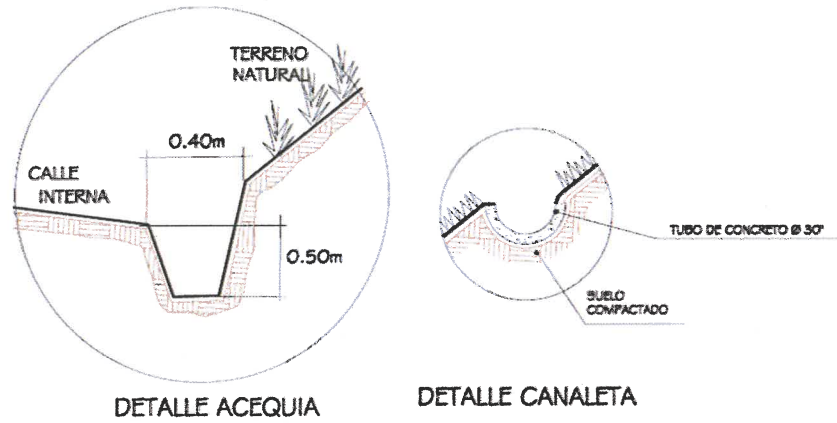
Drenajes Temporales Durante Construcción en el Sitio de la Central Térmica
